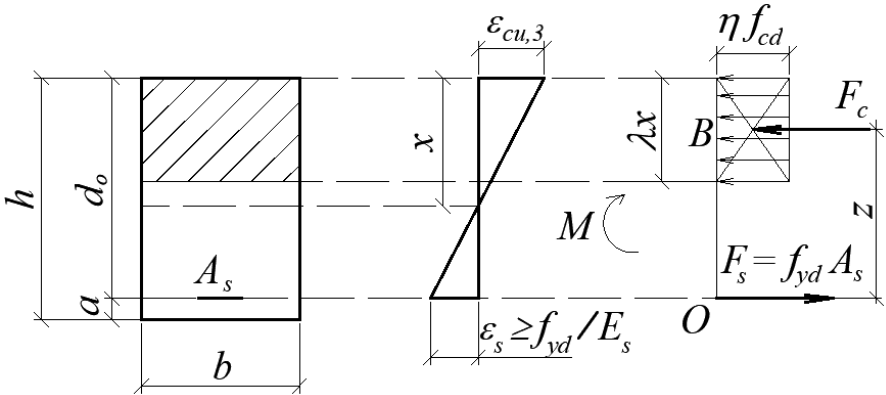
Розподіл деформацій, напружень та зусиль у нормальному перерізі з одиничним армуванням
